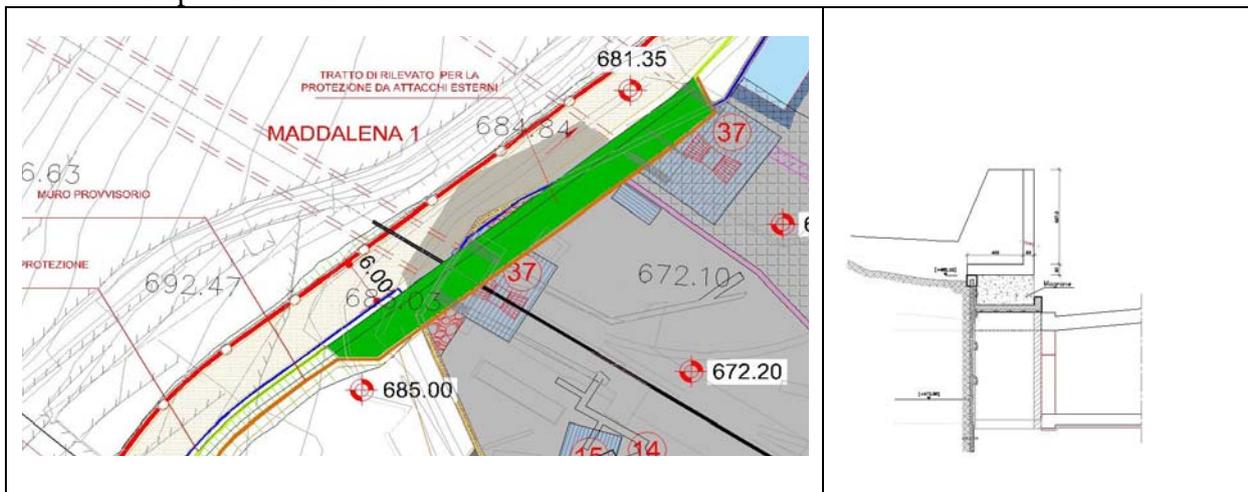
muro di protezione imbocco – pianta e sezione tipologica
